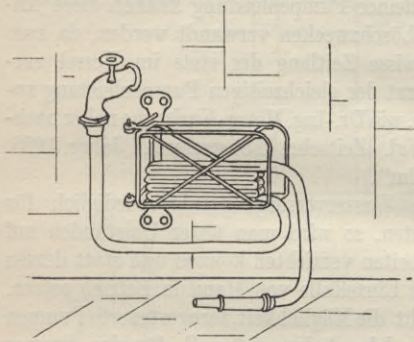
Wandhydrant, ausgerüstet mit Schlauch und Strahlrohr.
